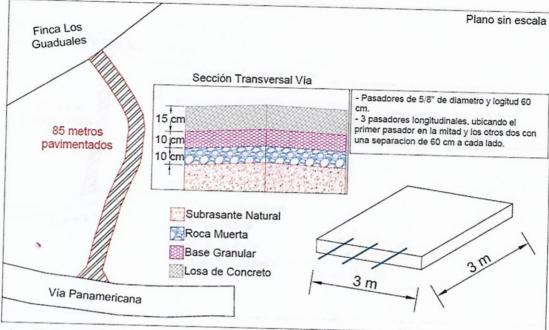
Plano y sección transversal carrera 13C sur entre calles 6 y 7 Sur
